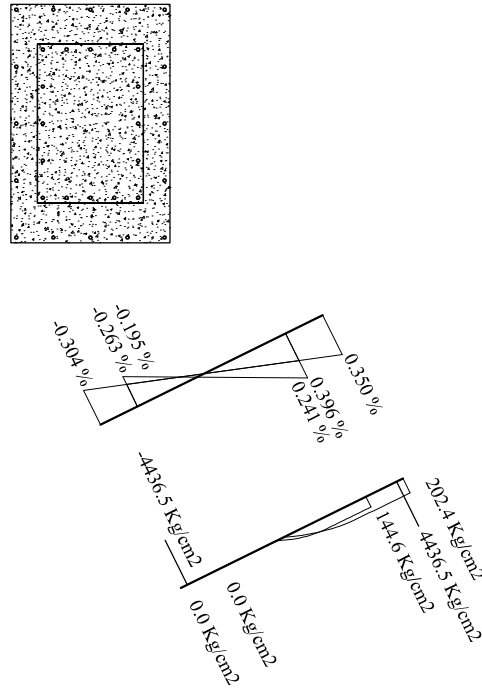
Plano de rotura de la sección reforzada, calculado con la metodología propuesta.
